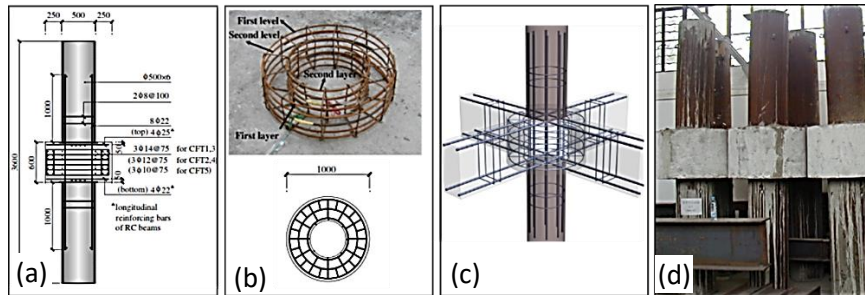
Nudo híbrido entre columna tubular de acero y viga de HA. (a) Detalle del nudo. (b) (c) Especimen ensayado. (Zhao, Xu, & Liu, 2014).
